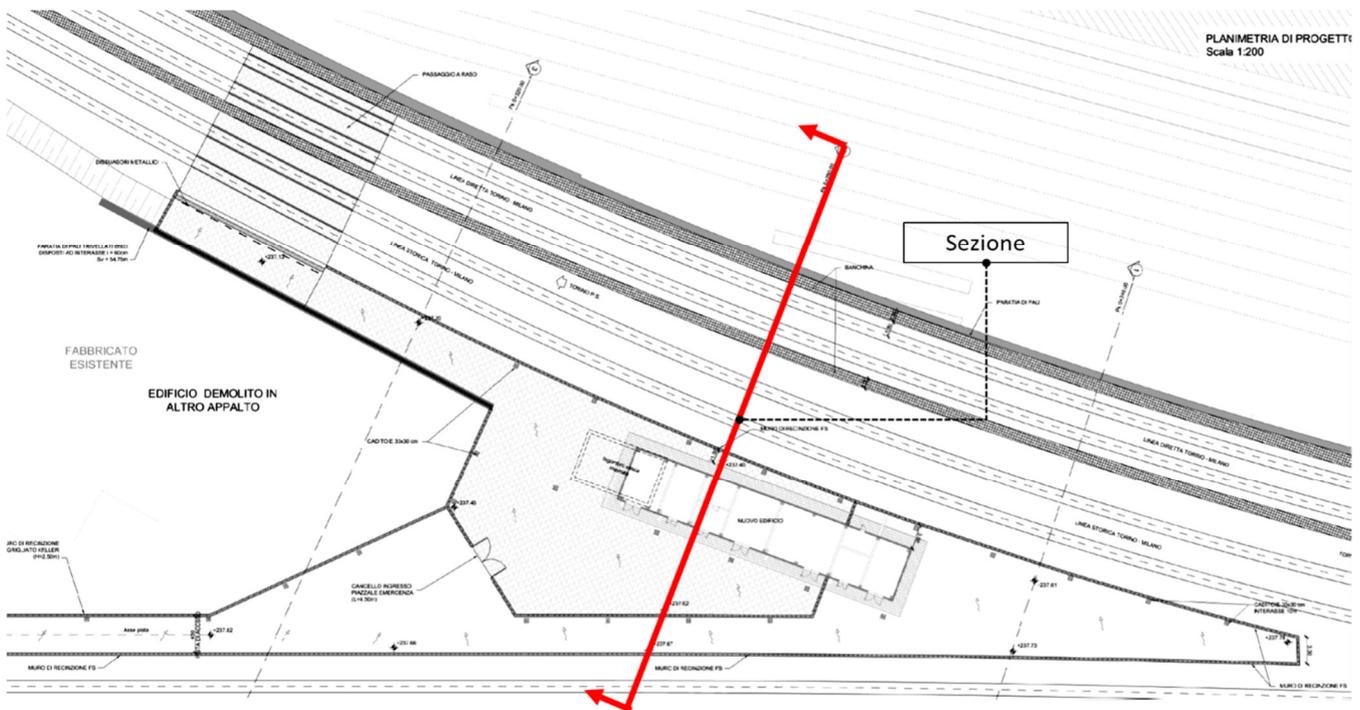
Planimetria piazzale emergenza e fabbricato tecnologico PGEP
